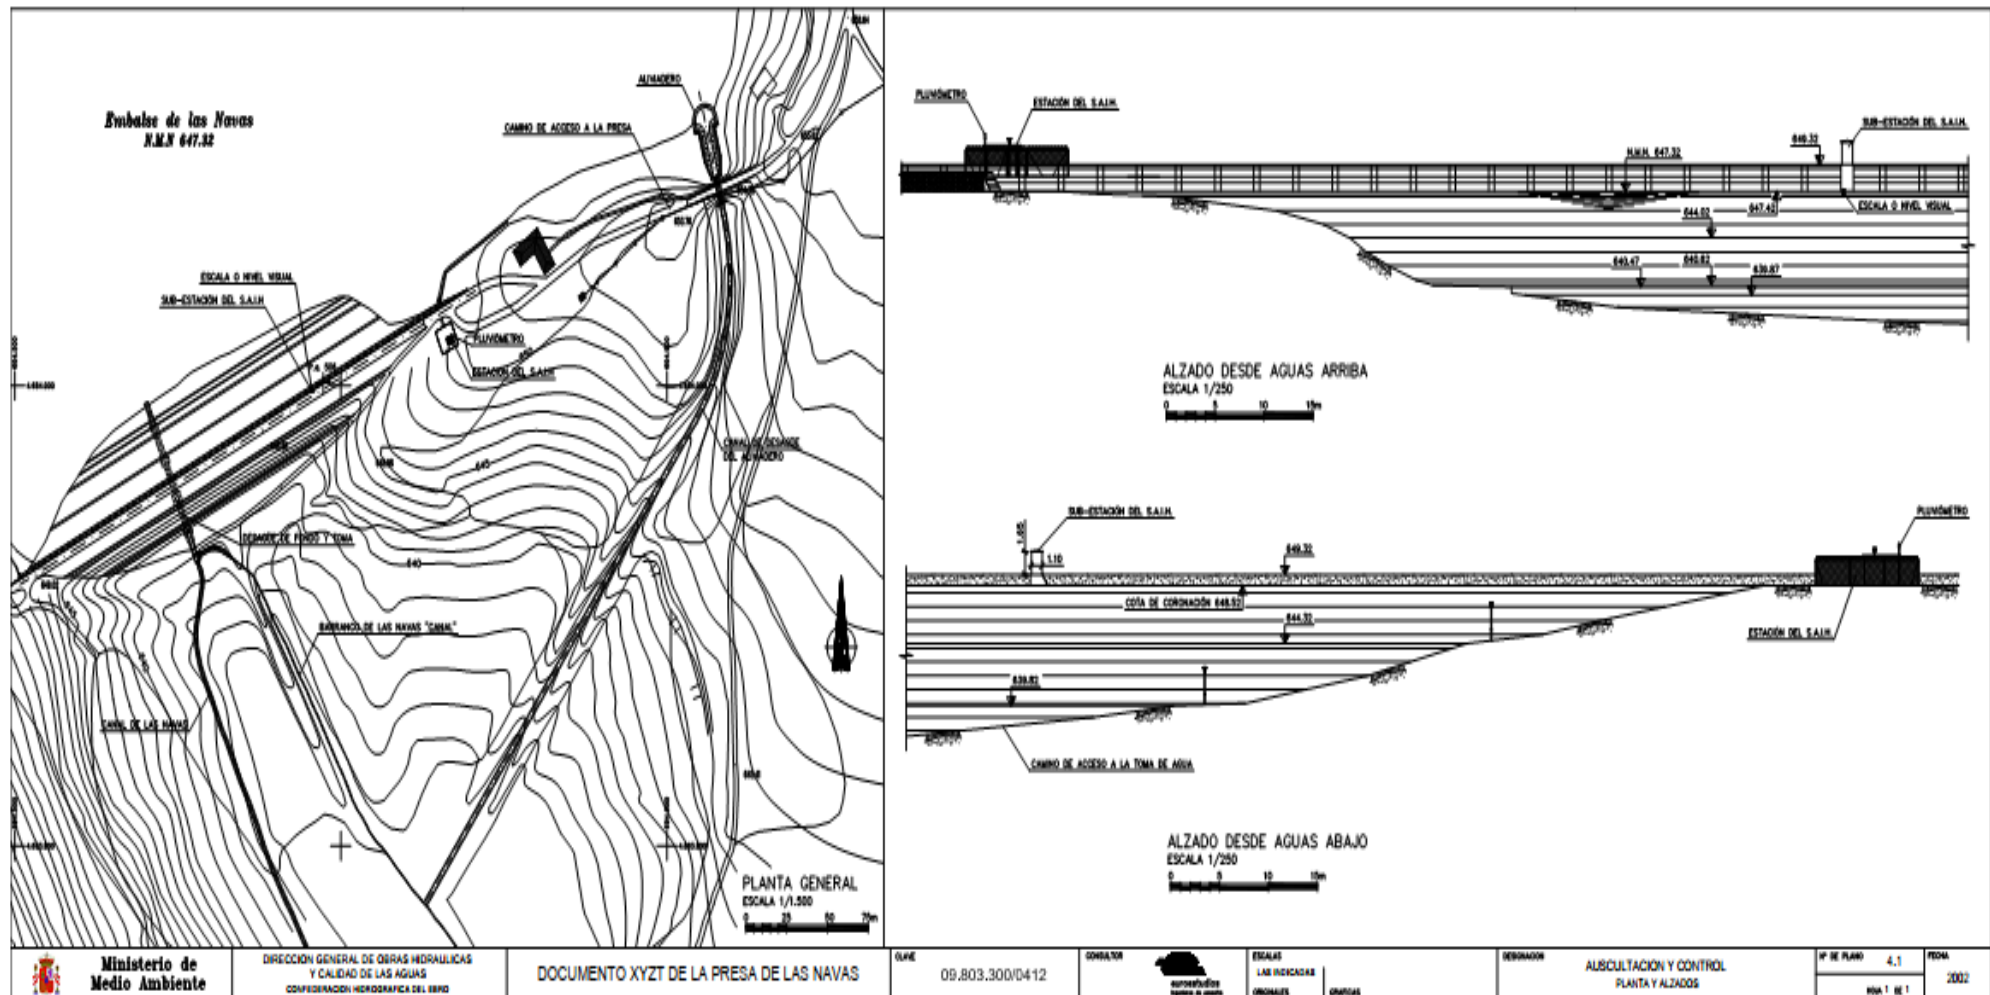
Plano 4.1. Auscultación y control. Planta y alzados. Fuente: documento XYZT de la presa de Las Navas (2003).
